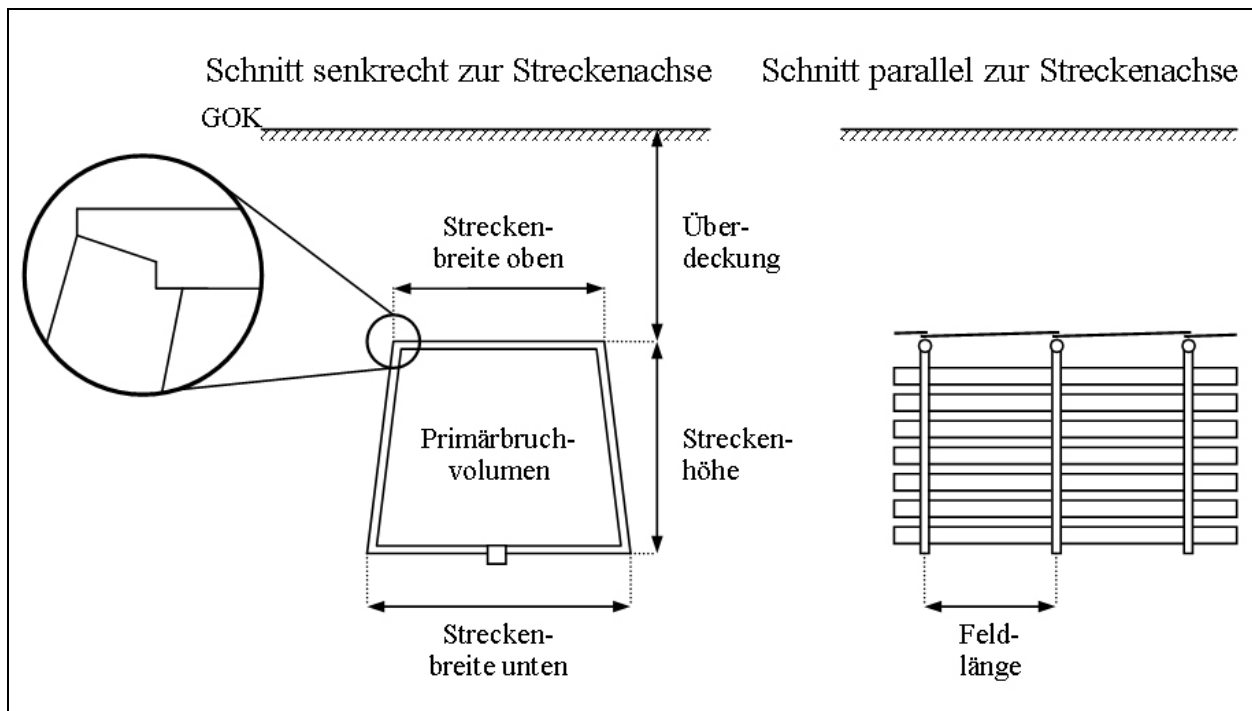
Schematische Darstellung einer typischen Strecke mit Holzausbau (Paralleltrapez)
